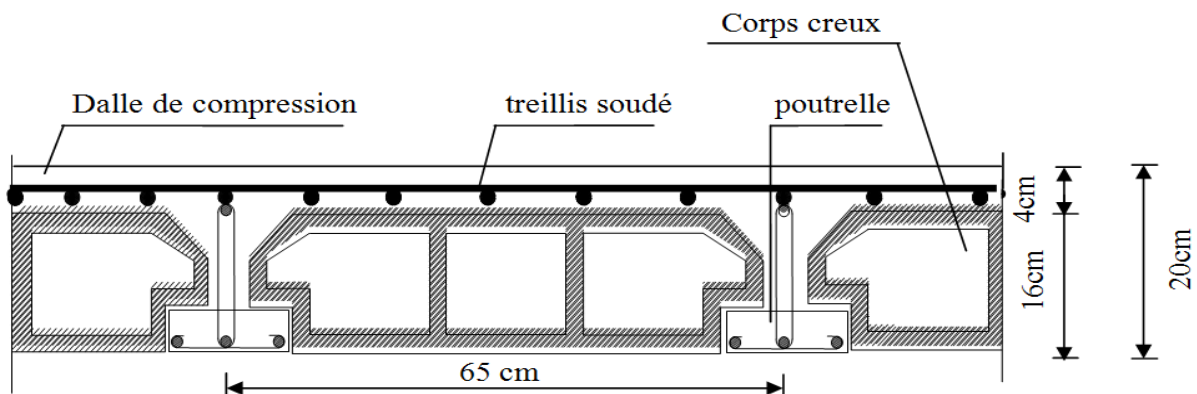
Schéma descriptif d'un plancher en corps creux
